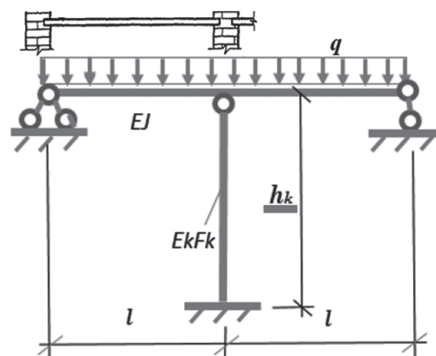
Начальная расчетная схема промежуточной опоры неразрезной двухпролетной балки перекрытия
